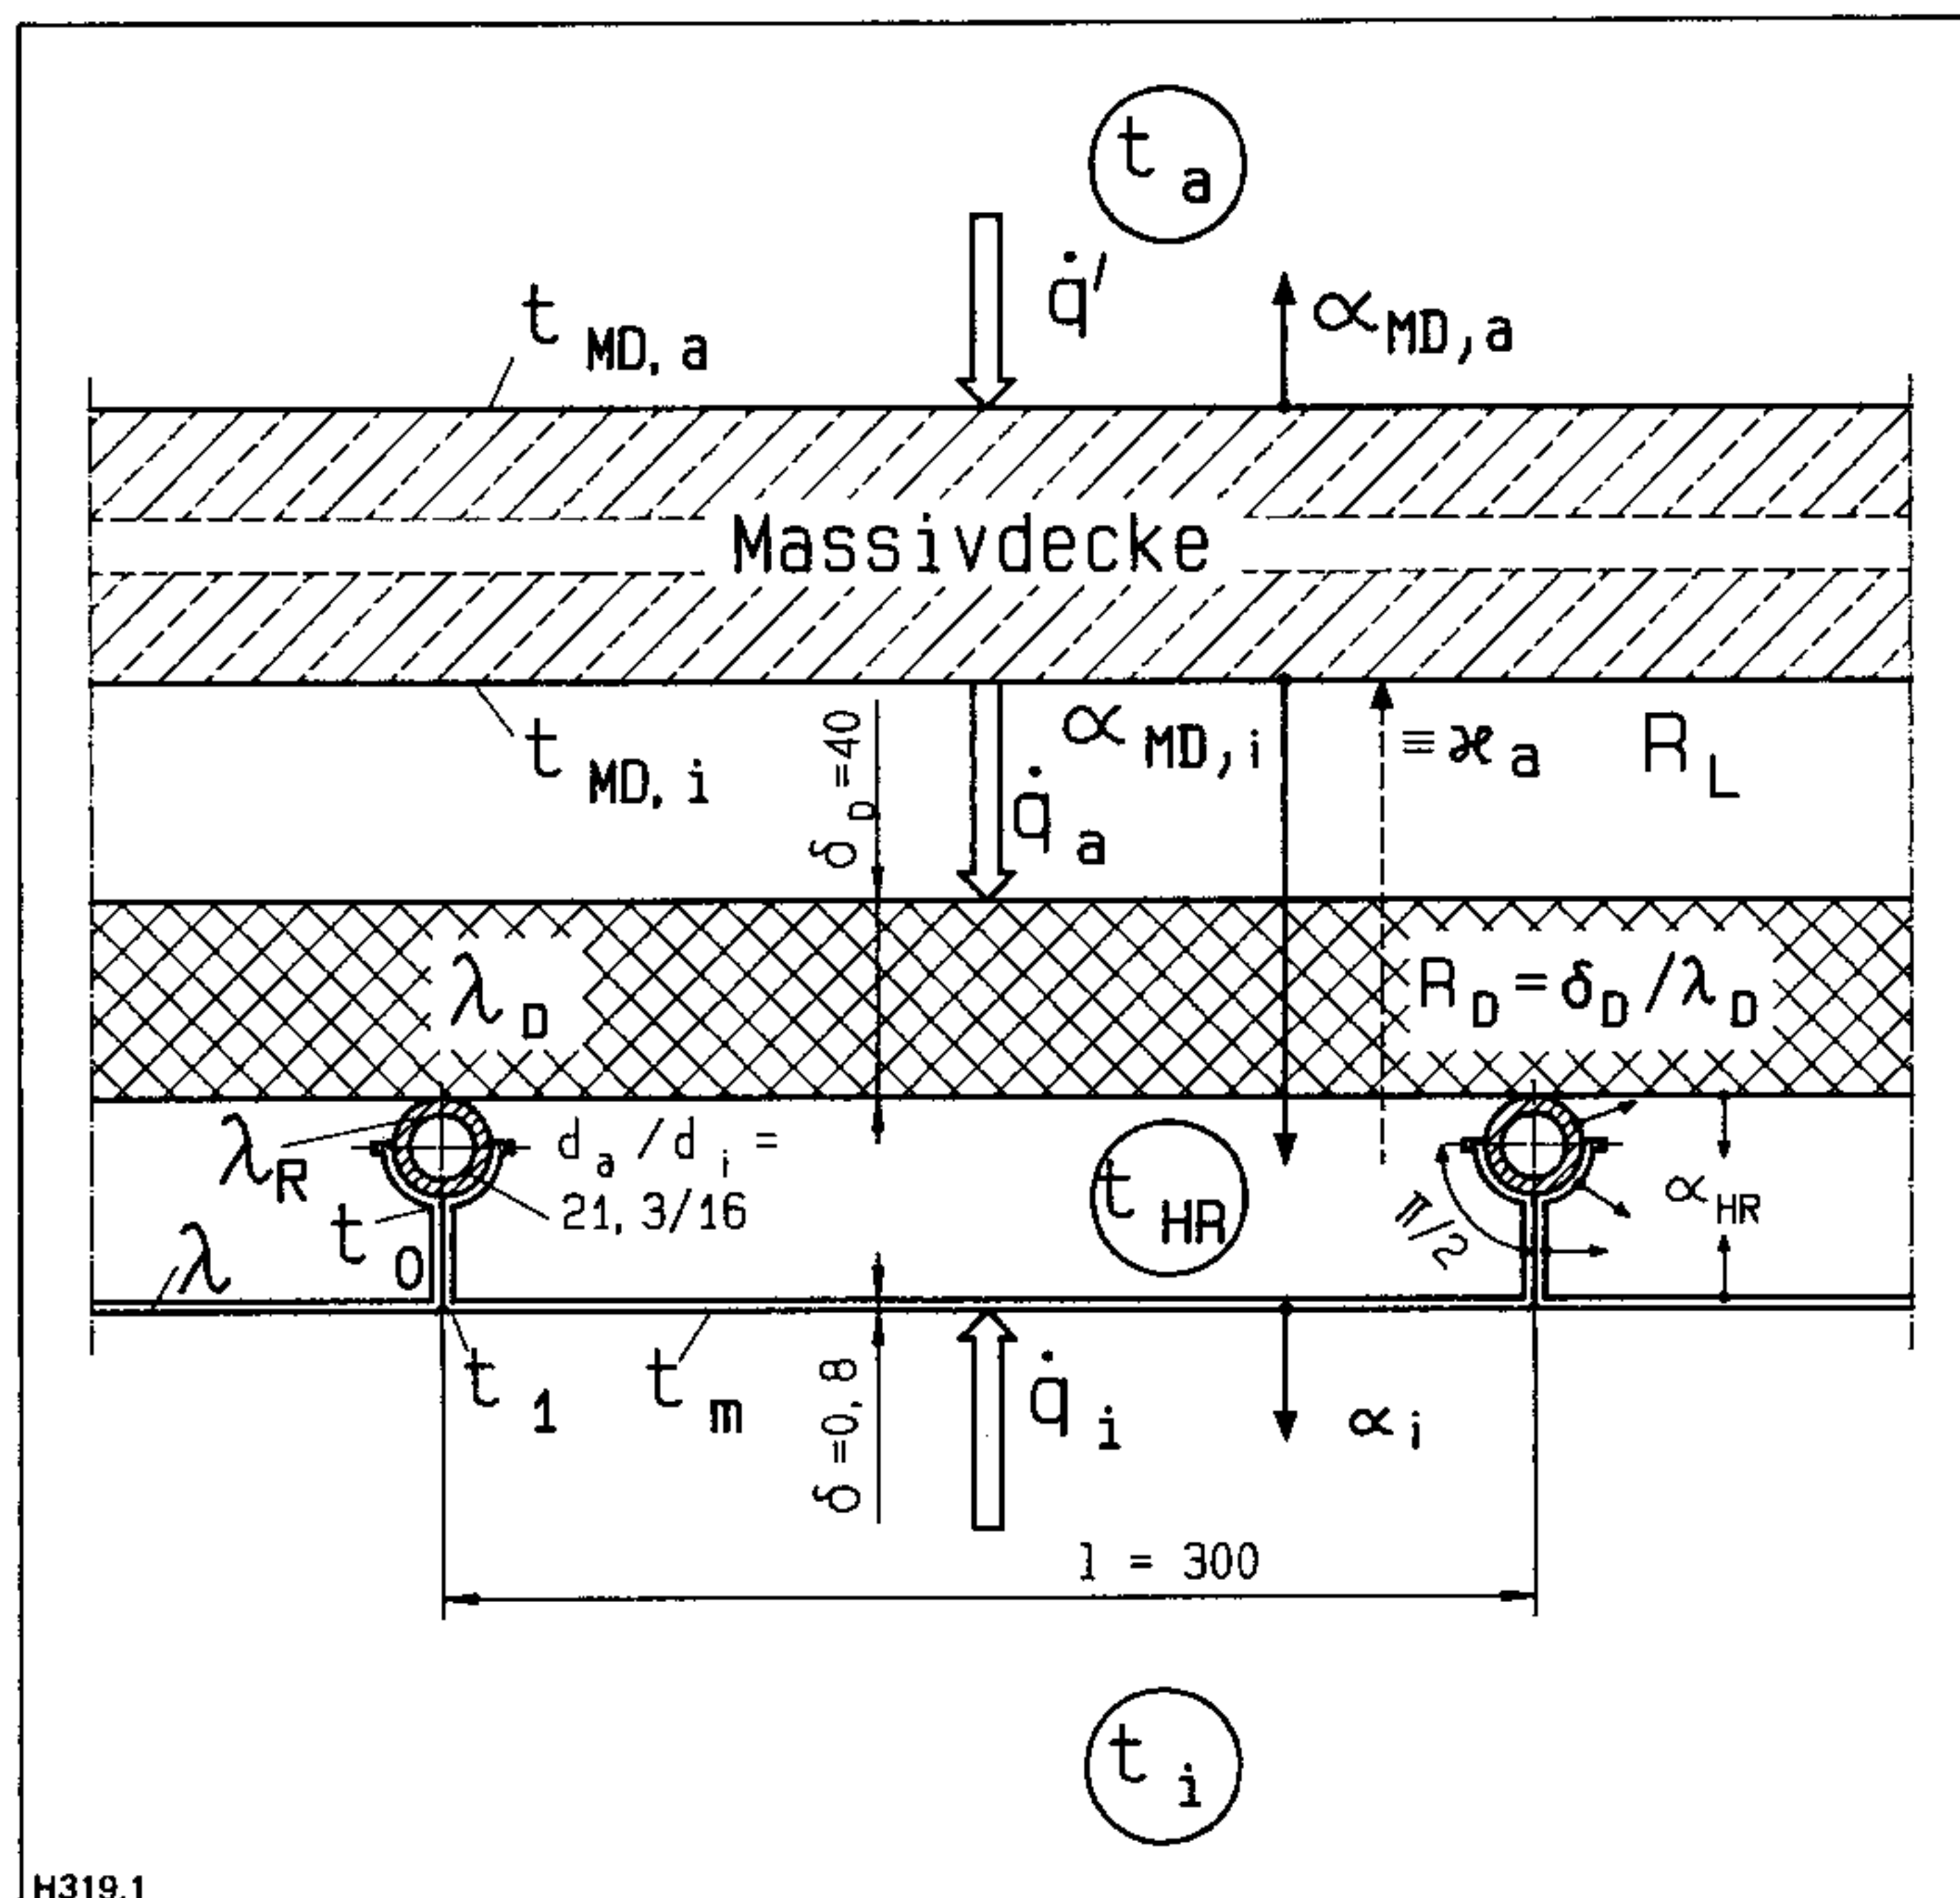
Massivdecke mit untergehängter, geschlossener Lamellen-Kühldecke und auf dem Rohrregister aufliegender Dämmmatte (Abmessungen in mm)
